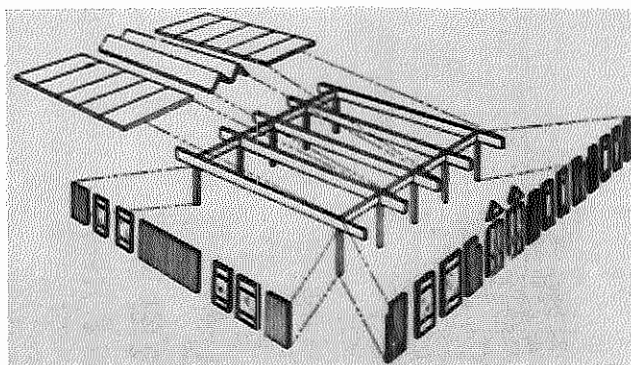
Coluna e Viga: “consiste usualmente de colunas e vigas pré-fabricadas, com painéis de função estrutural ou não. Os componentes podem ser suficientemente leves para instalação manual. Materiais: aço, madeira ou concreto.”
